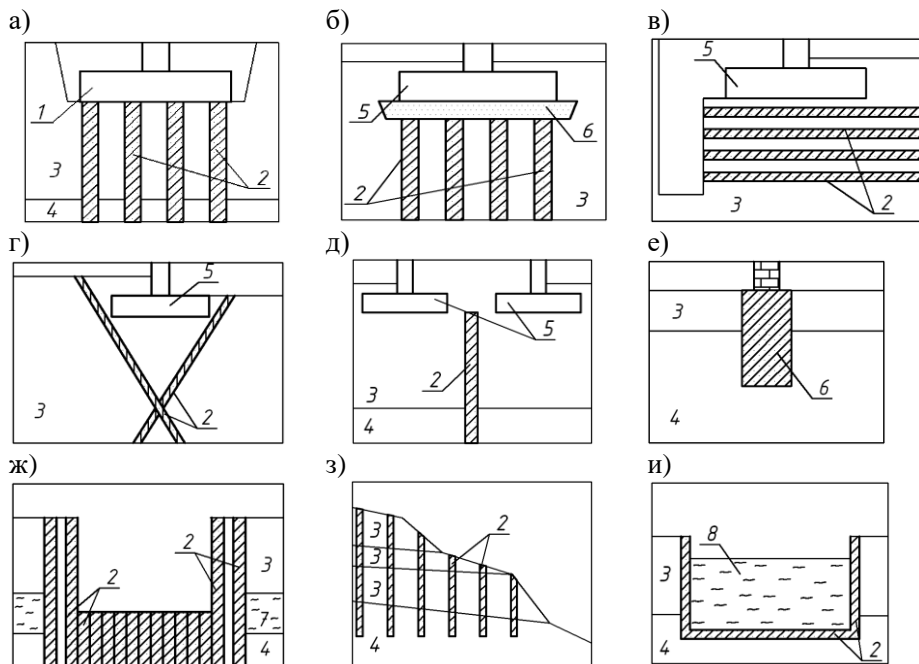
Использование грунтоцемента в геотехнике: а) – свайные фундаменты; усиление существующих фундаментов: б) – вертикальными ГЦЭ, в) – горизонтальными ГЦЭ, г) – наклонными ГЦЭ; д) – устройство разделительных экранов; е) – устройство фундаментов малого заложения под малоэтажные здания; ж) – усиление откосов котлована и защита от грунтовых вод; з) – закрепление неустойчивых откосов и склонов; и) – устройство резервуаров; 1- ростверк; 2 - грунтоцементные элементы; 3 - слабый грунт; 4 – прочный грунт; 5 – фундамент; 6 – ленточный фундамент из грунтоцемента; 7 – водонасыщенный грунт; 8 – жидкость резервуаров
